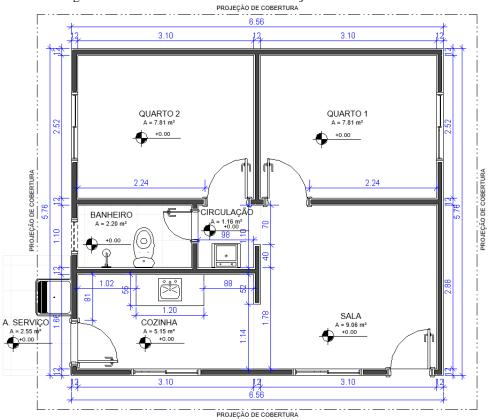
Planta baixa – Residência do Conjunto Morada do Vale I
